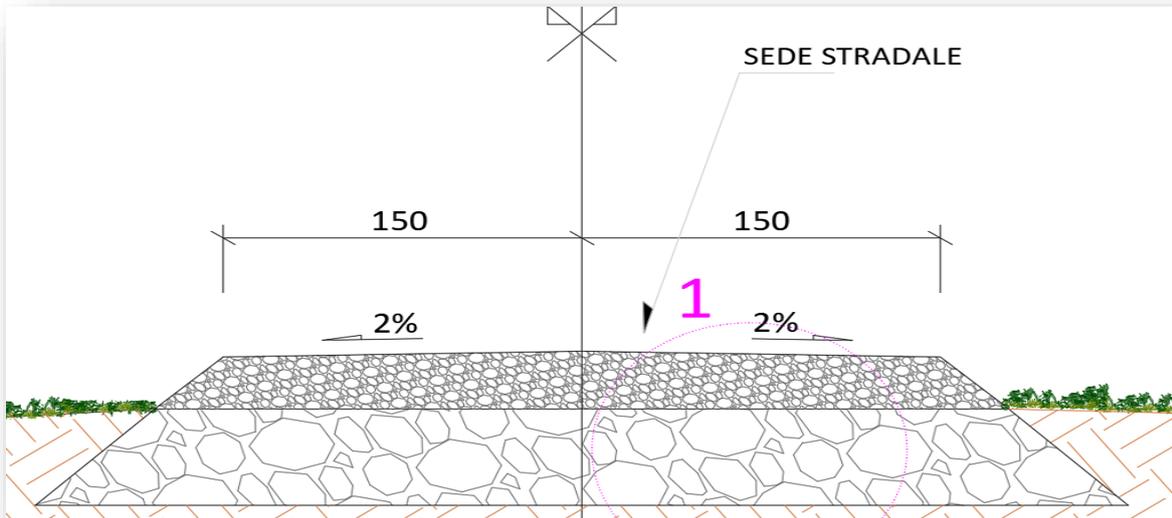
Estratto elaborato (Sezione stradale tipo)
